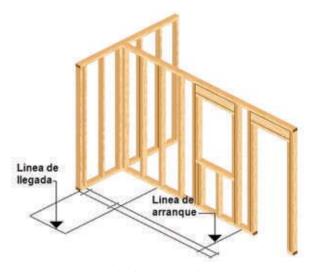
23: Trazado de largo y ancho de la escalera en proyección horizontal.
